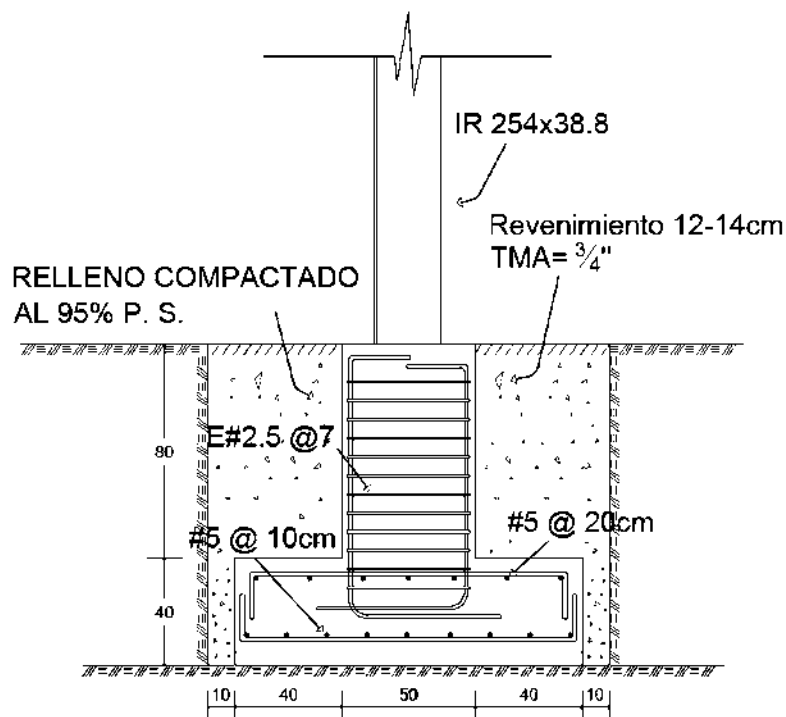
(d) Vista en alzado de la zapata, en dirección longitudinal de la cubierta,
